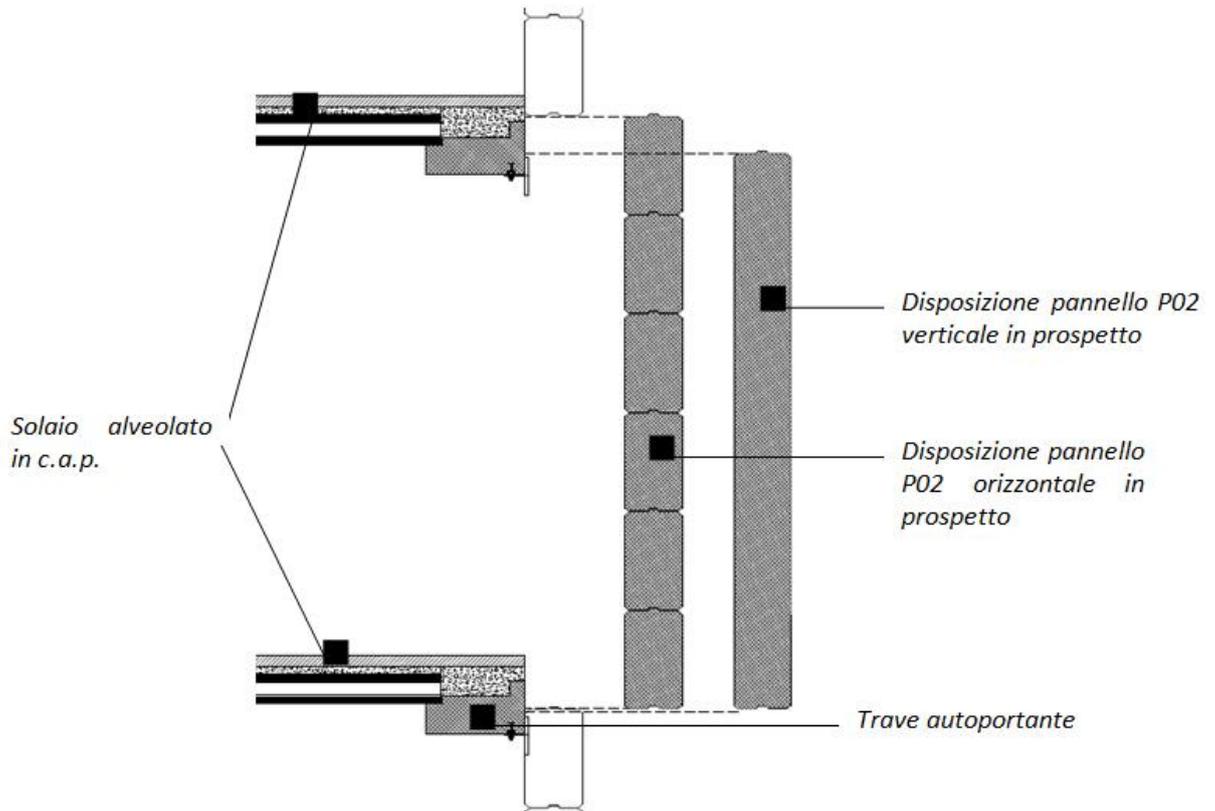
Pannello P02 disposto in verticale o orizzontale rispetto la struttura in elevazione
